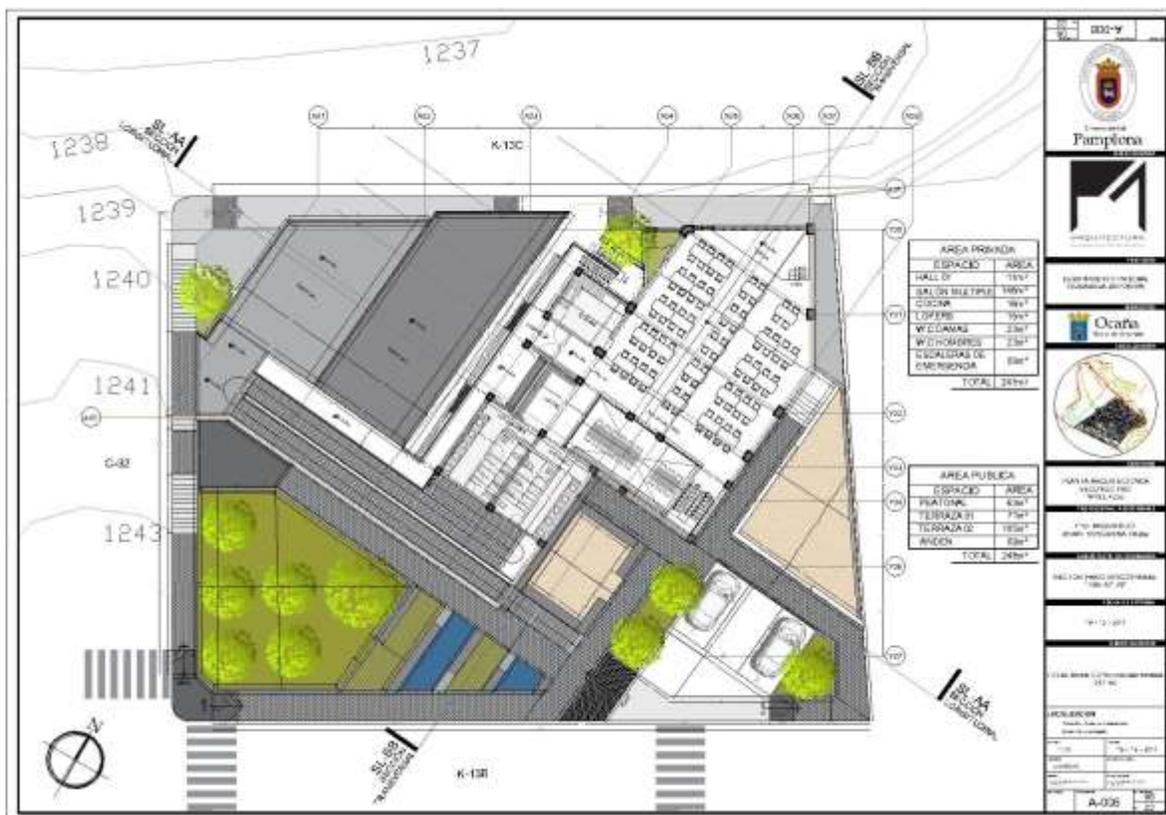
Planta Arquitectónica Nivel 0.00.
